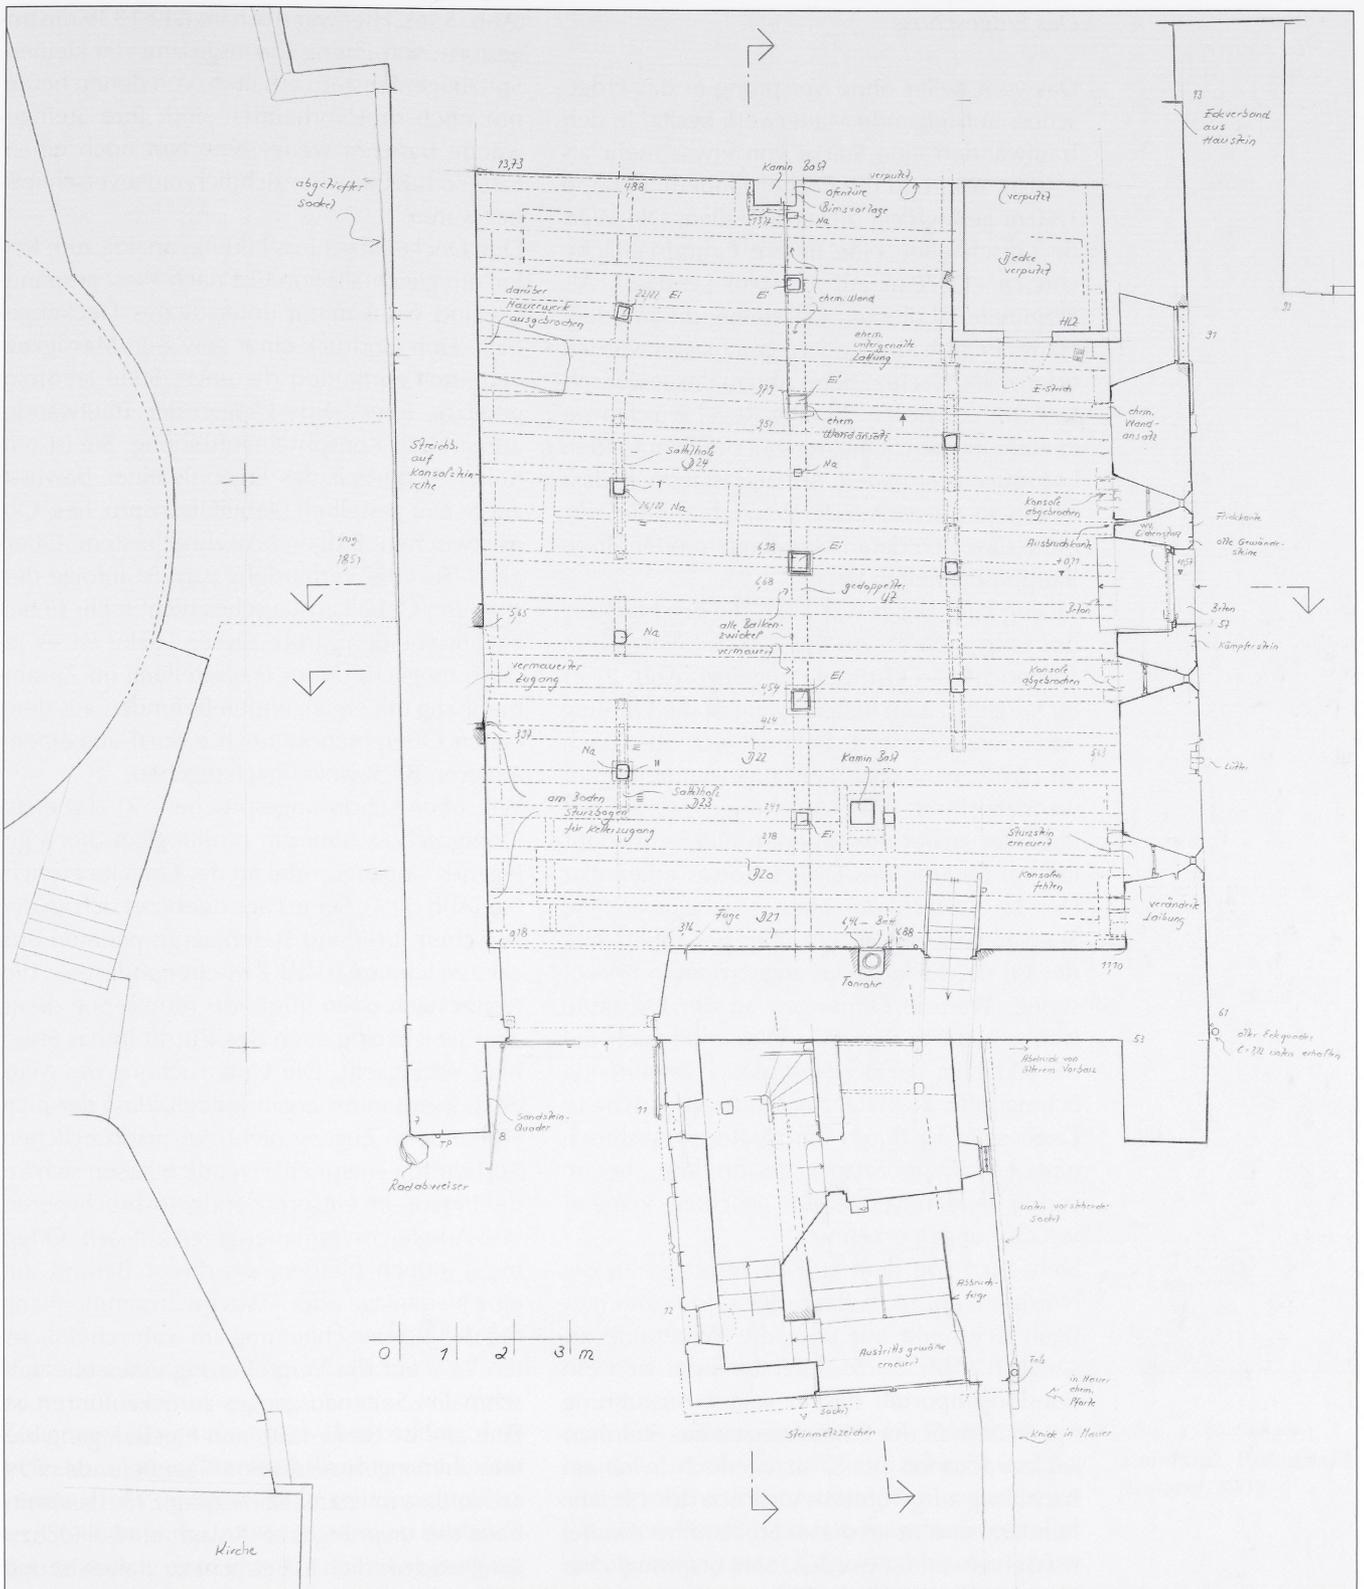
Besigheim, Steinhaus. Grundriss Erdgeschoss, Bestand 1997.
